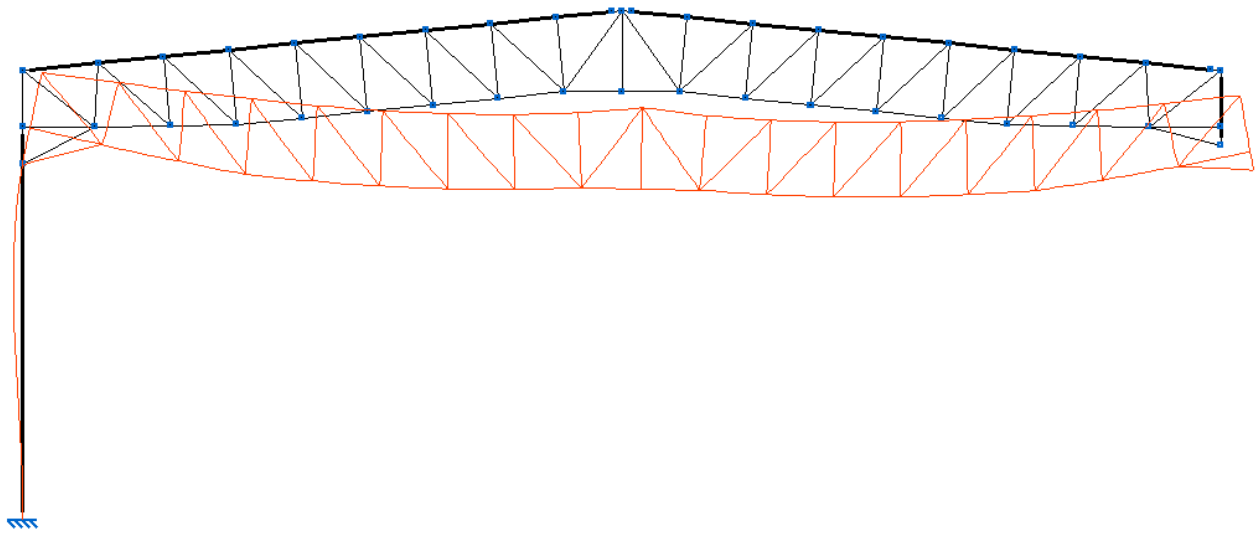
Envolvente de Deformada. – Pórtico Tipo N°1. Fuente: Elaboración propia.
